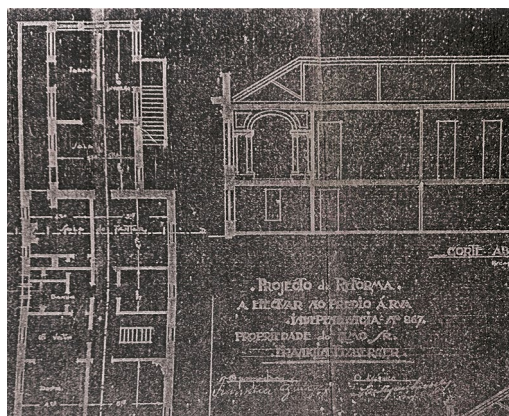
Planta de reforma, apresentada à prefeitura em 1928.¹⁷³
